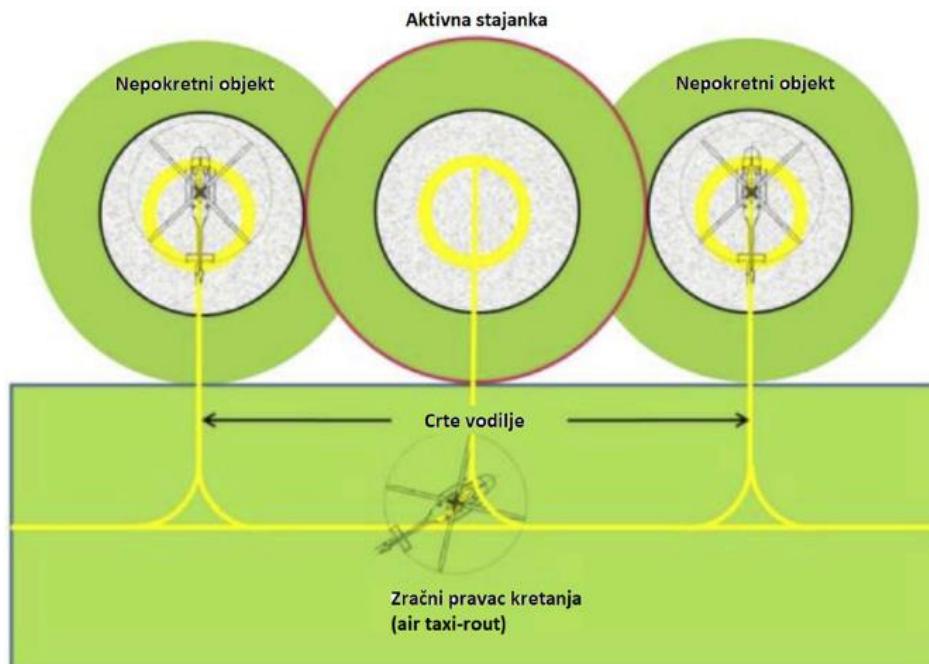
Pravac kretanja na tlu preko stajanki (sa stazom za vožnju/pravcem kretanja na tlu) – istovremene operacije
